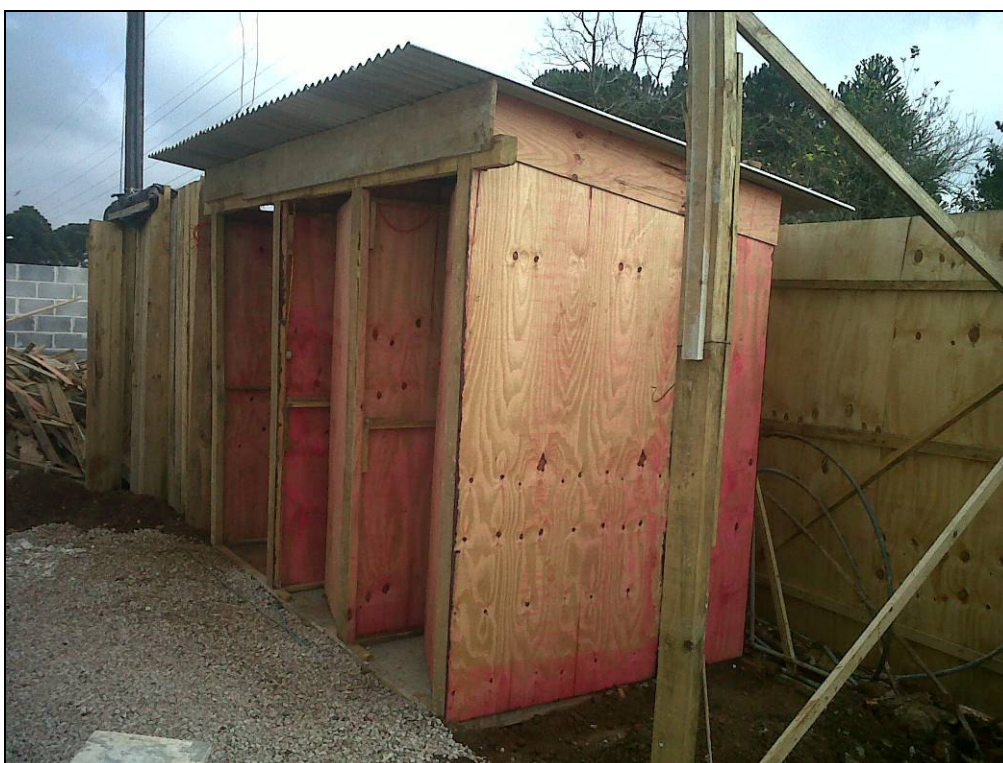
Banheiro da obra D (Obra Médio porte)
